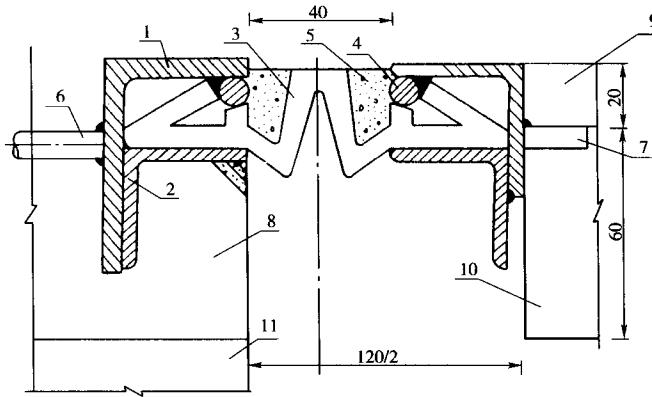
SD II 型橡胶伸缩装置构造示意图(尺寸单位:mm)
